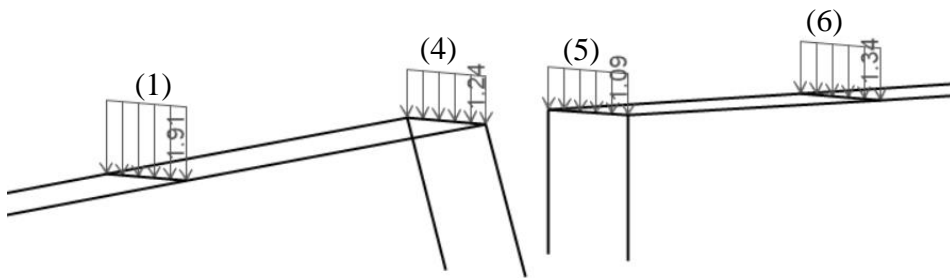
Sobrecarga nas Travessas na ligação dos Troços Inclinado e Horizontal
